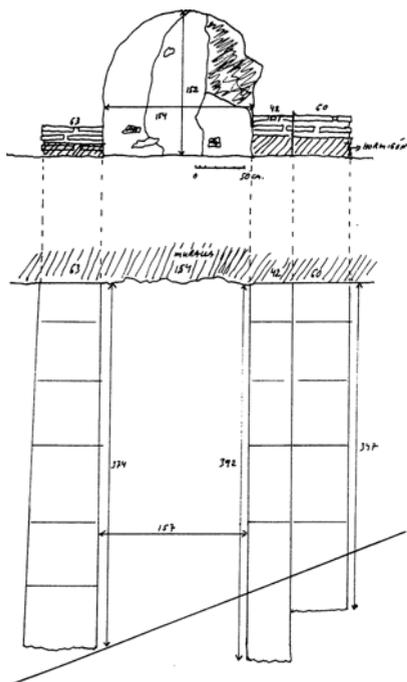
Planta y alzado del exterior del postigo del Secano. (Dibujo C. Vílchez).
